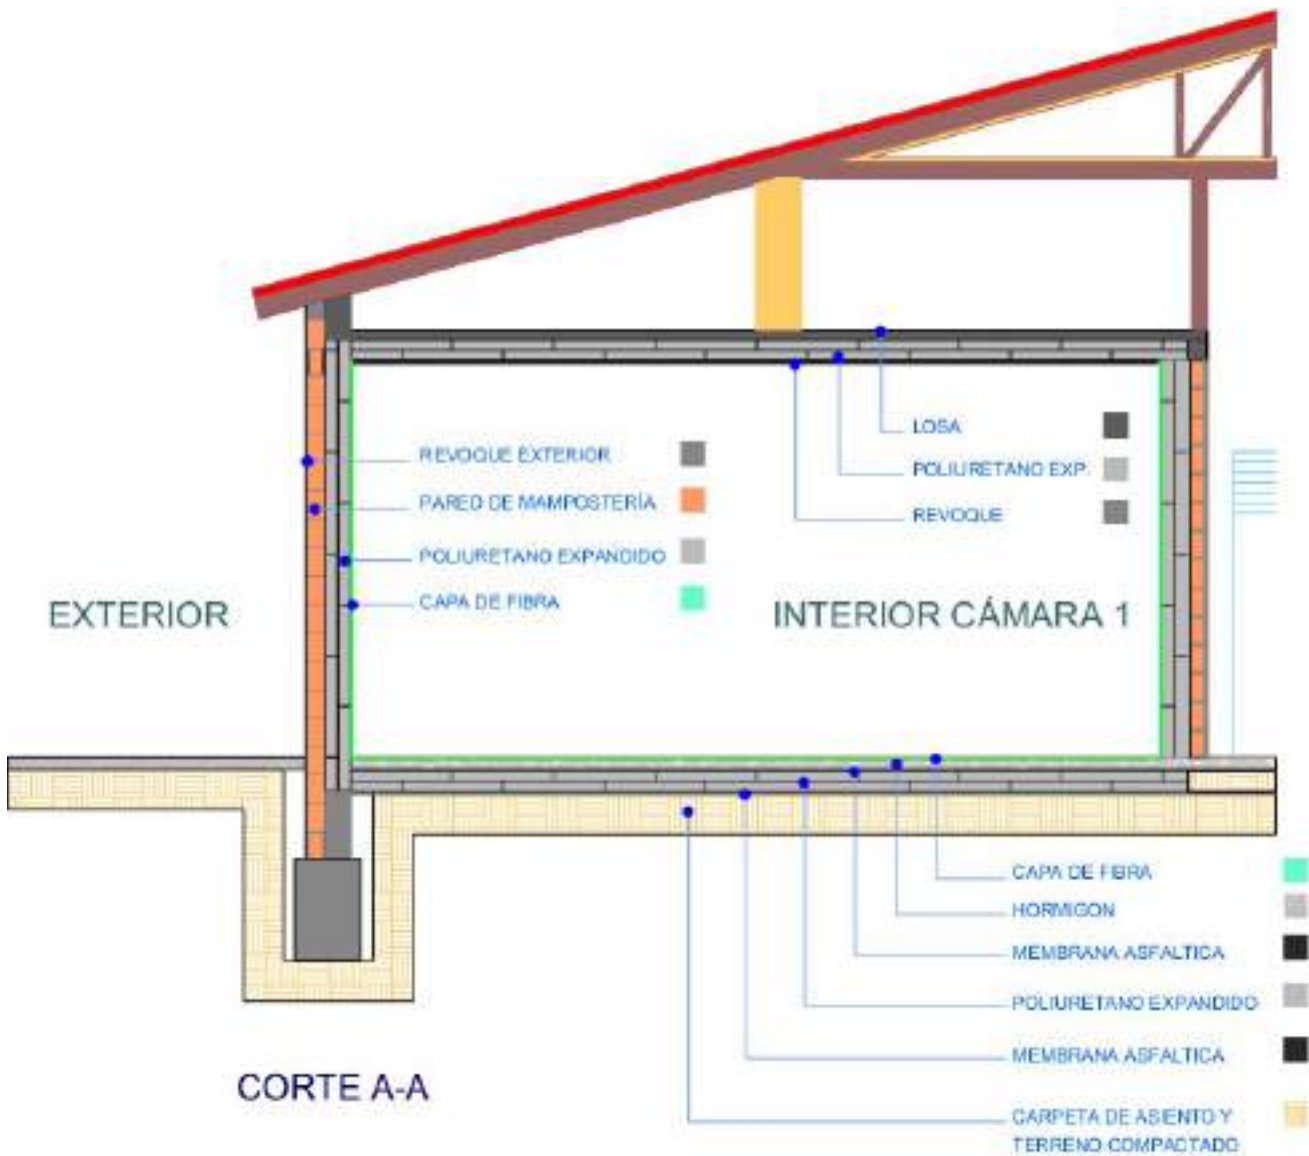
Detalle de construcción de las cámaras de almacenamiento
